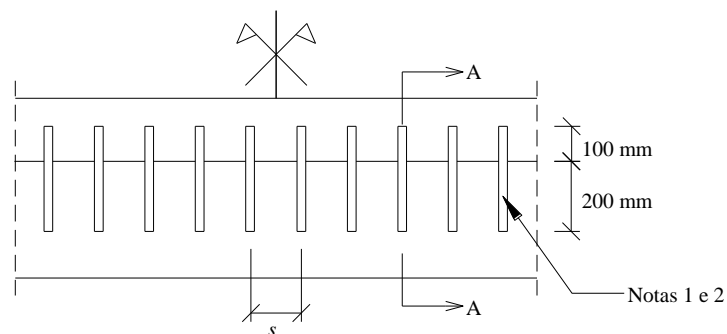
Secção longitudinal do sistema de ligação.
